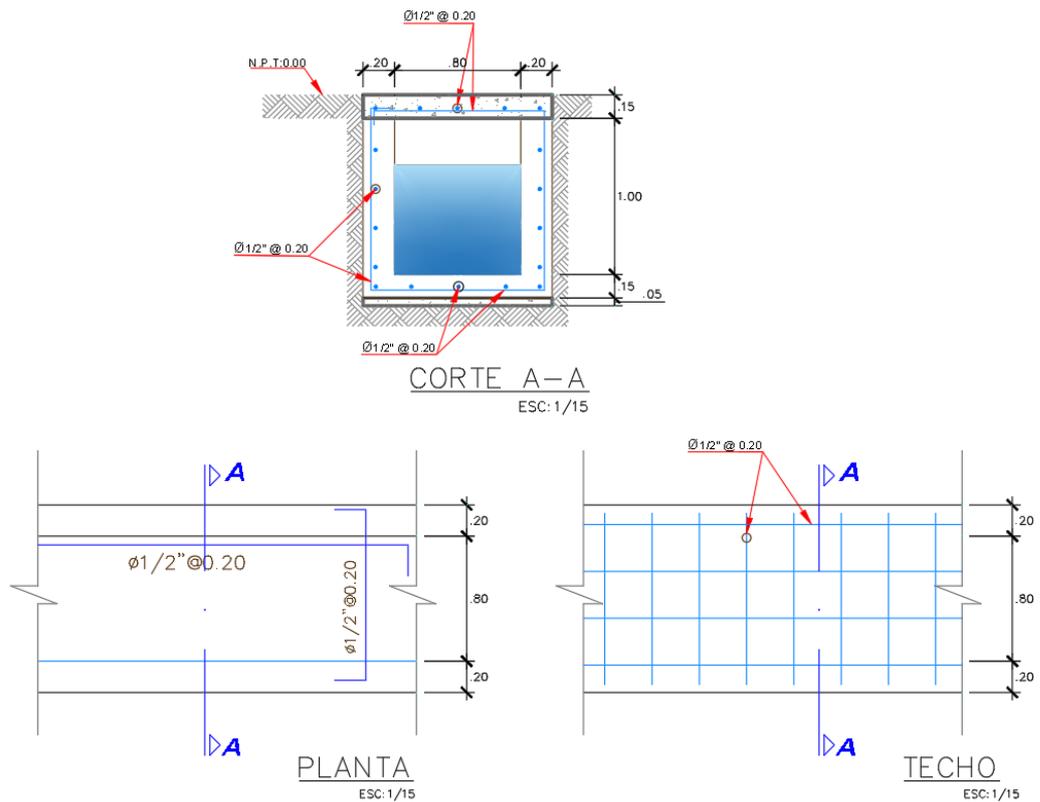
Plano Estructural del Canal Cerrado. (Fuente: Expediente Técnico)
